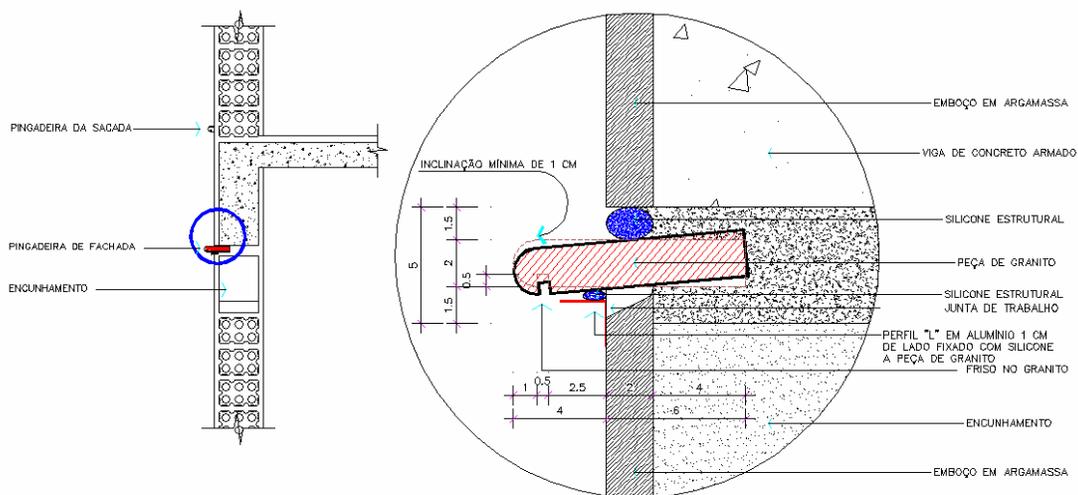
Detalhe da pingadeira de fachada com pedra de granito branco.
